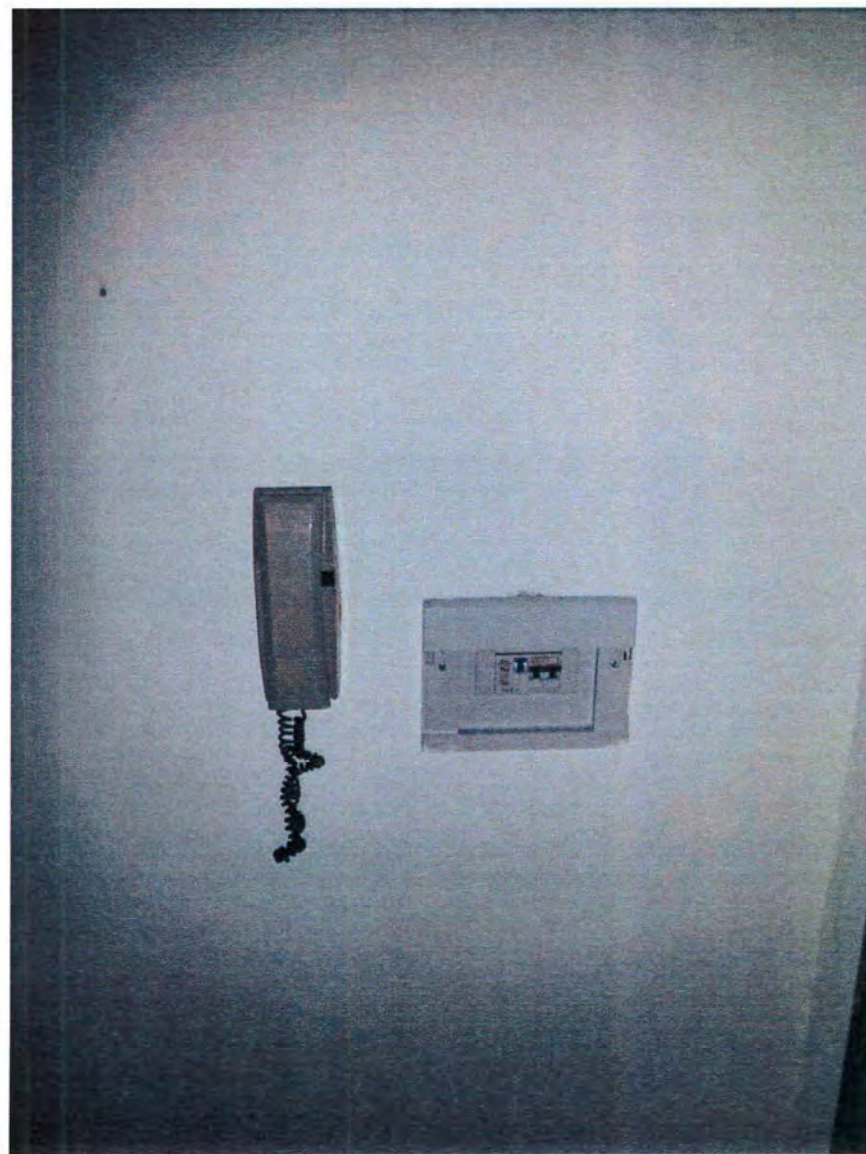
Particolare Zona ingresso (citofono e quadretto distribuzione energia elettrica);
